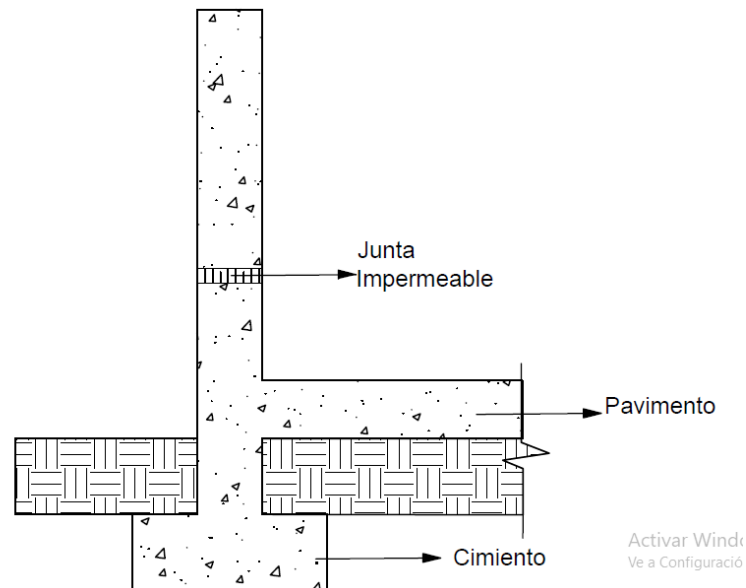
Corte Transversal en un Muro Tratado con Juntas Impermeables.
